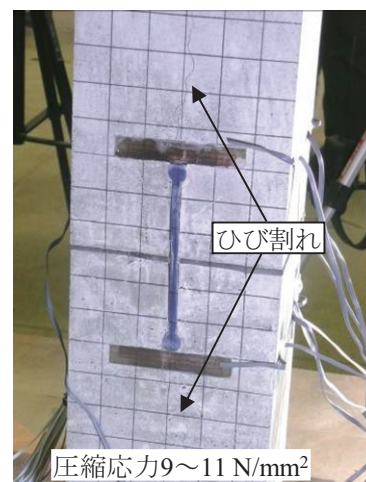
供試体 2 の荷重途中のひび割れ発生状況
